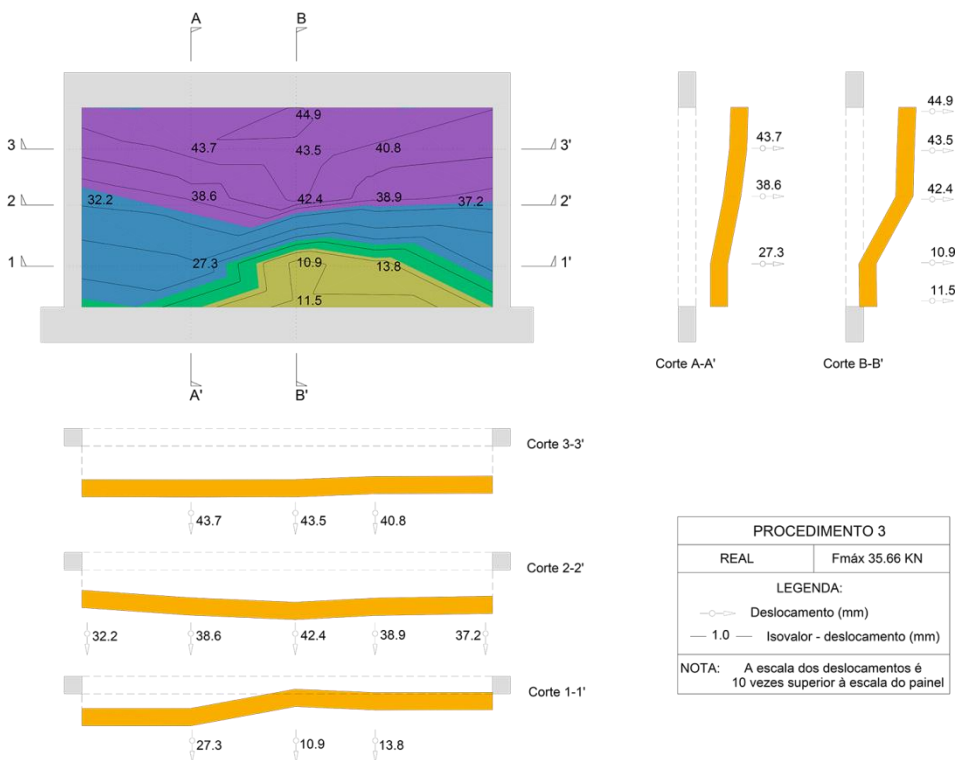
Isovalores da parede ensaiada - Procedimento 3. Ensaio fora do plano, Wall_RAR_02.
